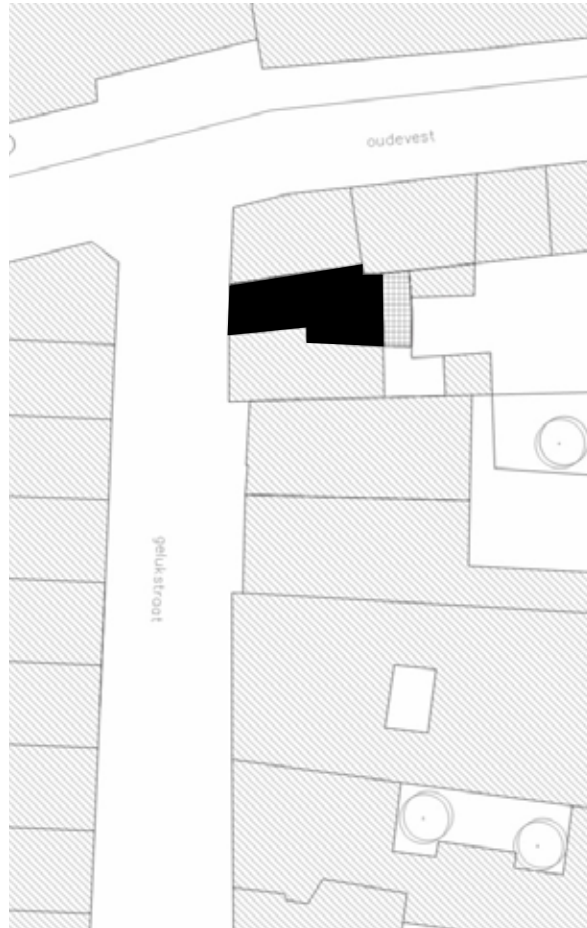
Lageplan, Quelle: Dierendonckblancke Architecten
